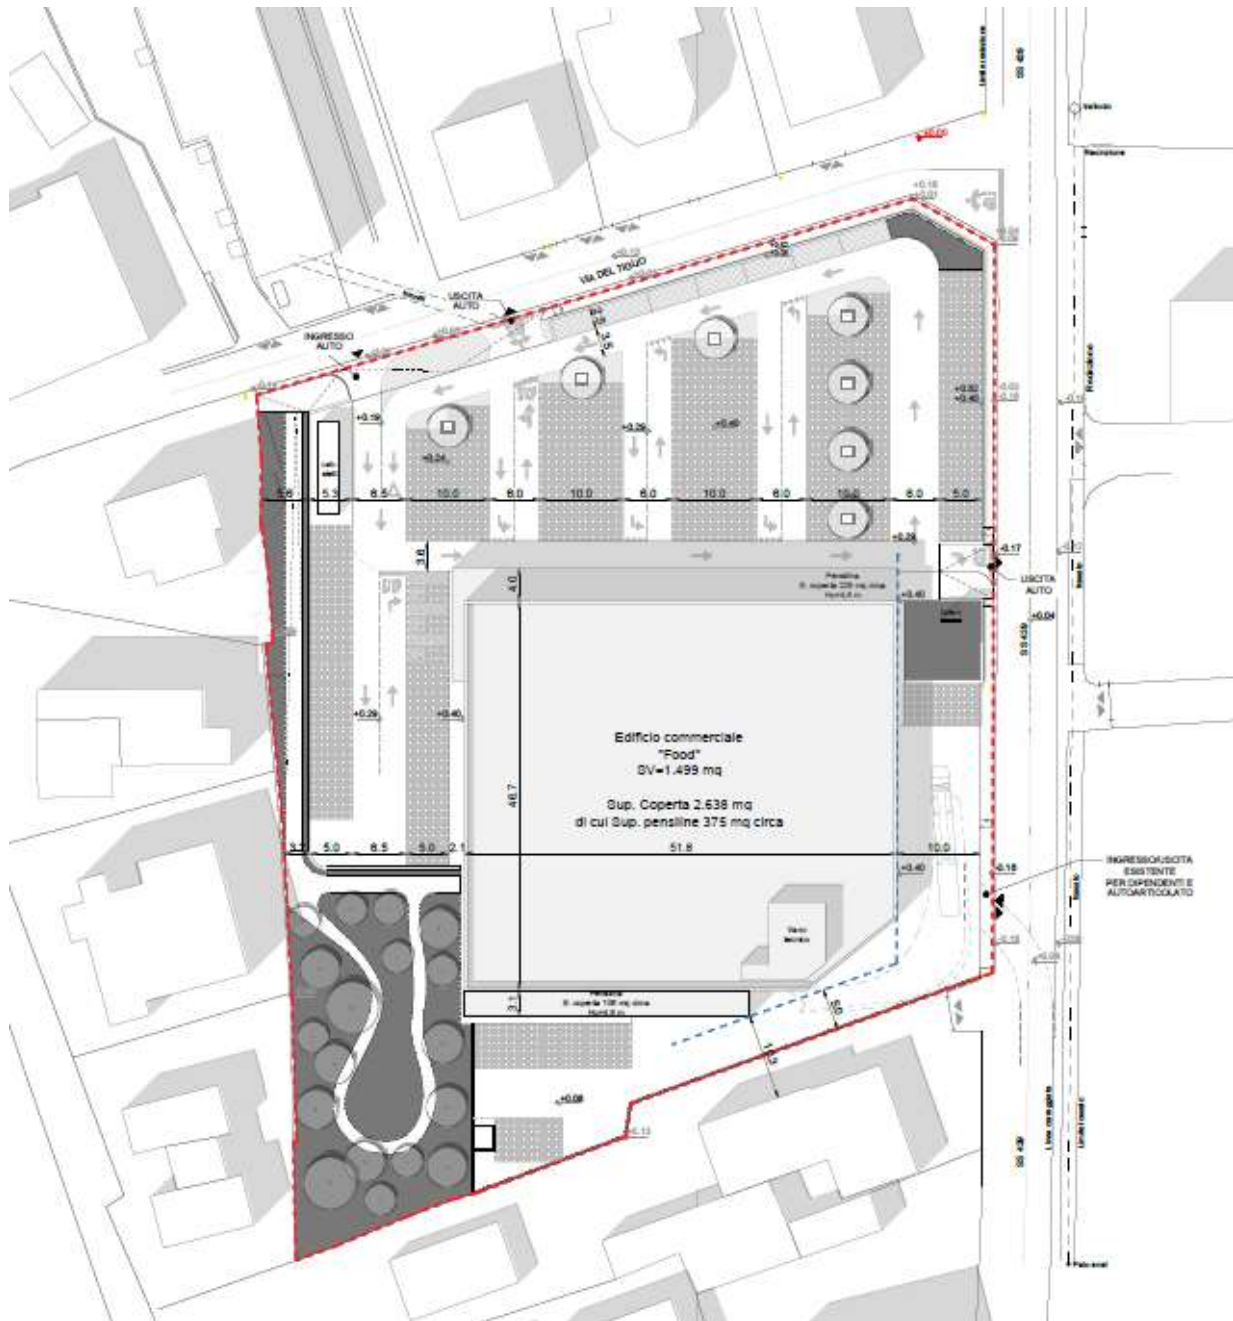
Estratto progettuale di planoaltimetrico della zona di interesse, con sovrapposizione del progetto di nuova realizzazione
